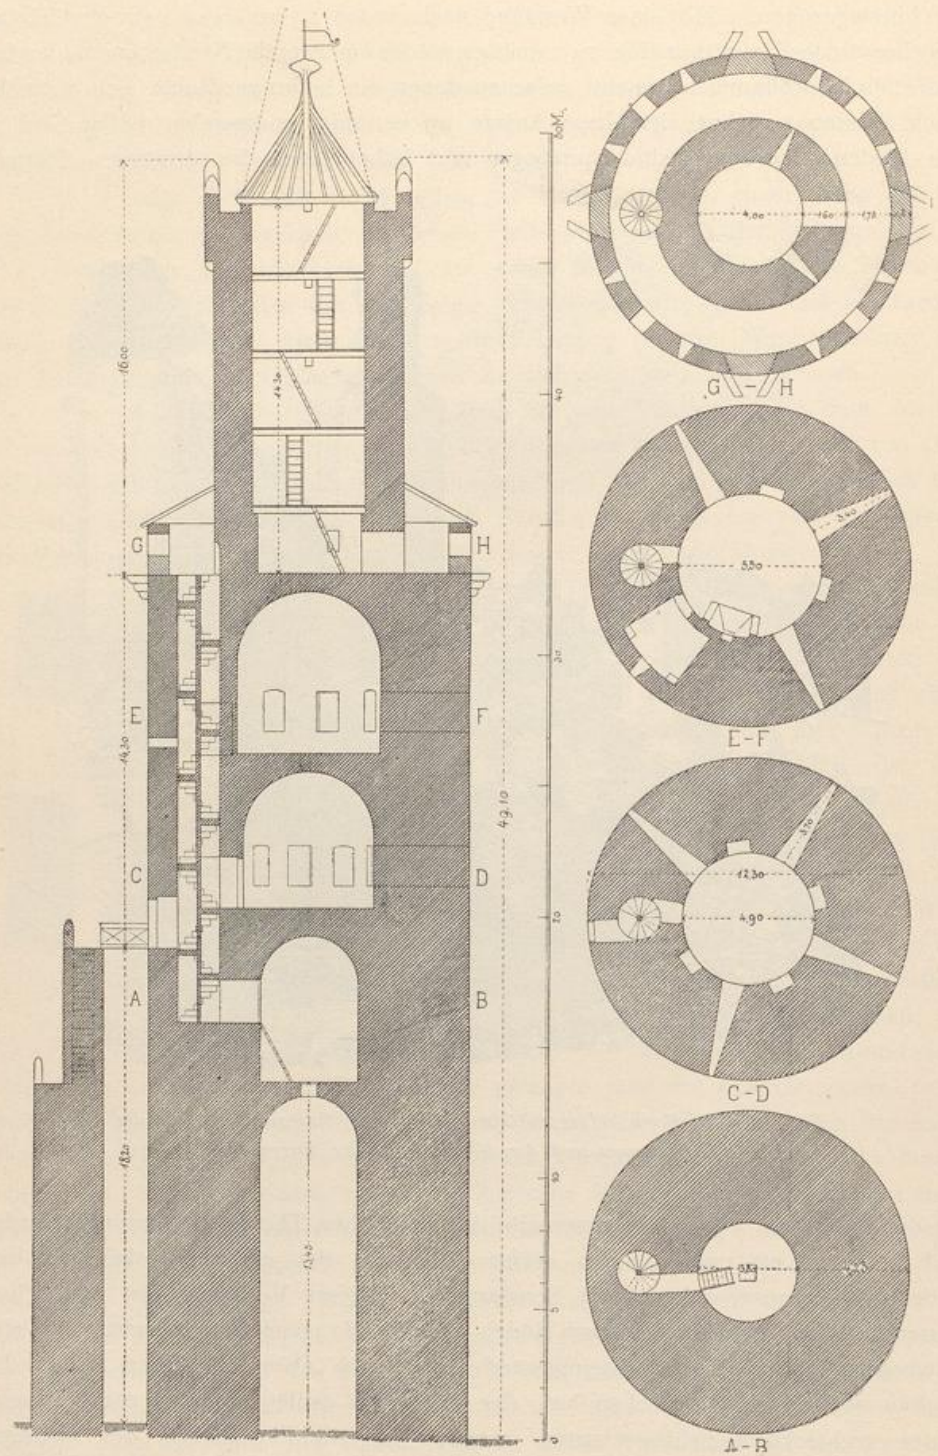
Friedberg. Der Adolfsturm. Grundrisse und Schnitt.
